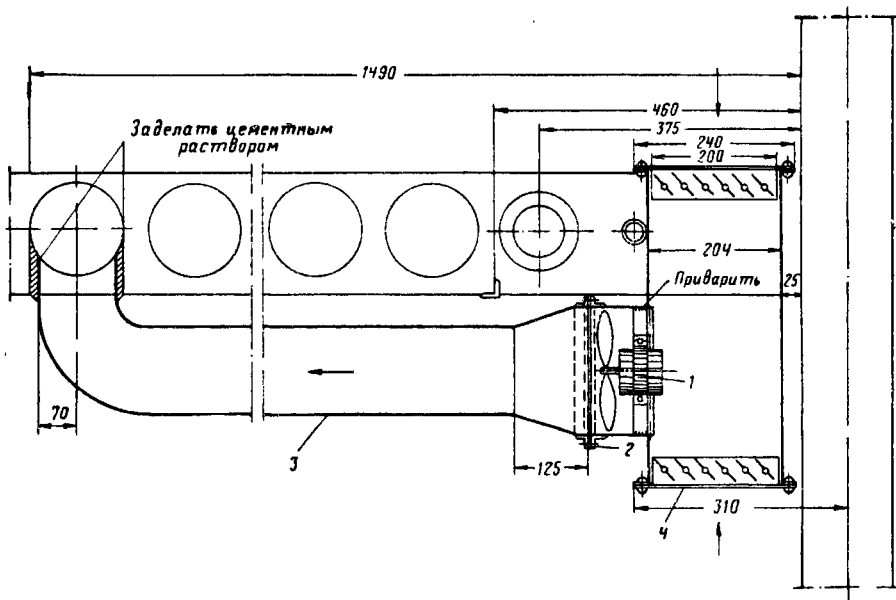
Установка индивидуального вытяжного вентилятора для вентиляции кухни и санузла
